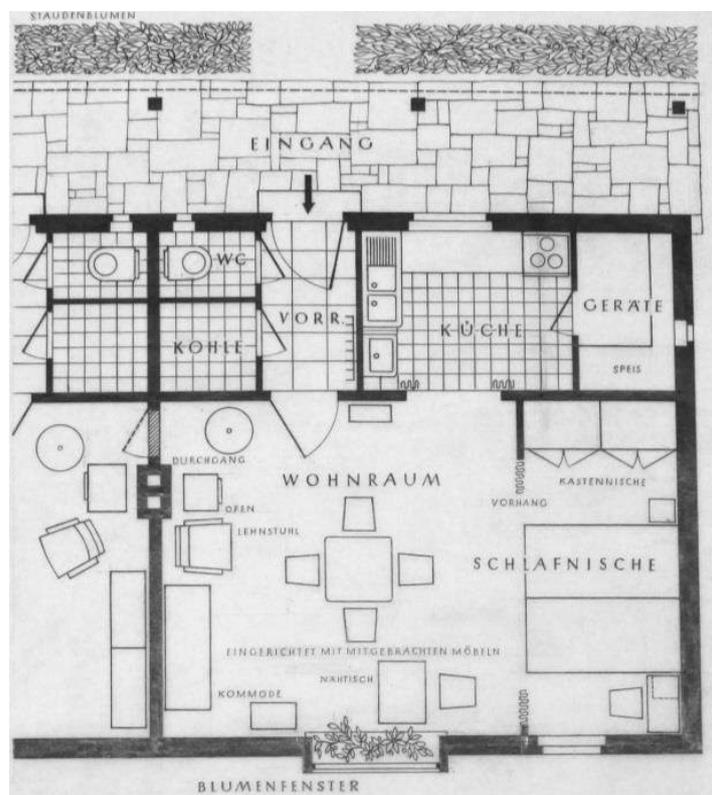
Grundriss einer Wohneinheit für zwei Personen
